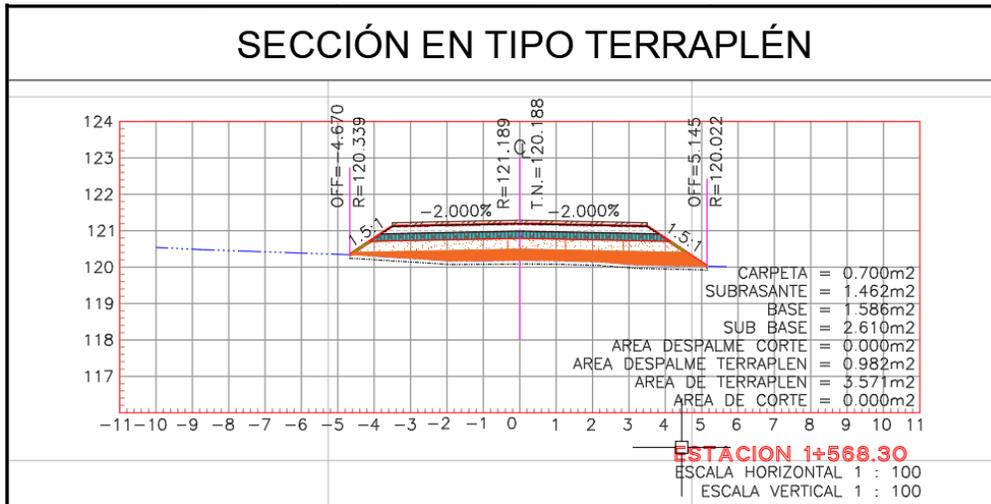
Secciones de Terreno Proyecto, con volumetría de Terraplén
